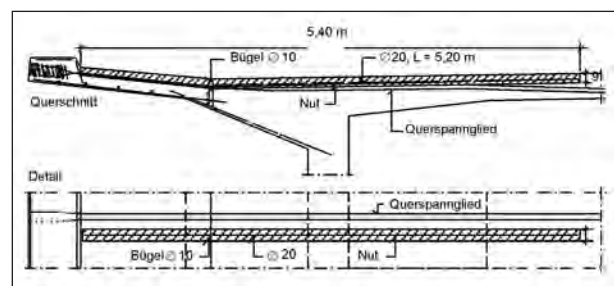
Fußgängerbrücke Gera-Lusan, neue Längsbewehrung in Nuten
